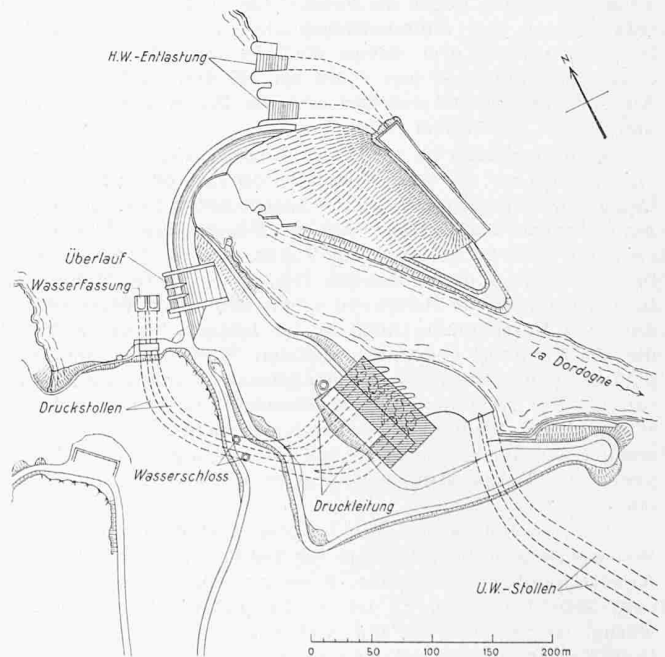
Kraftwerk Marèges, Lageplan 1 : 6000
